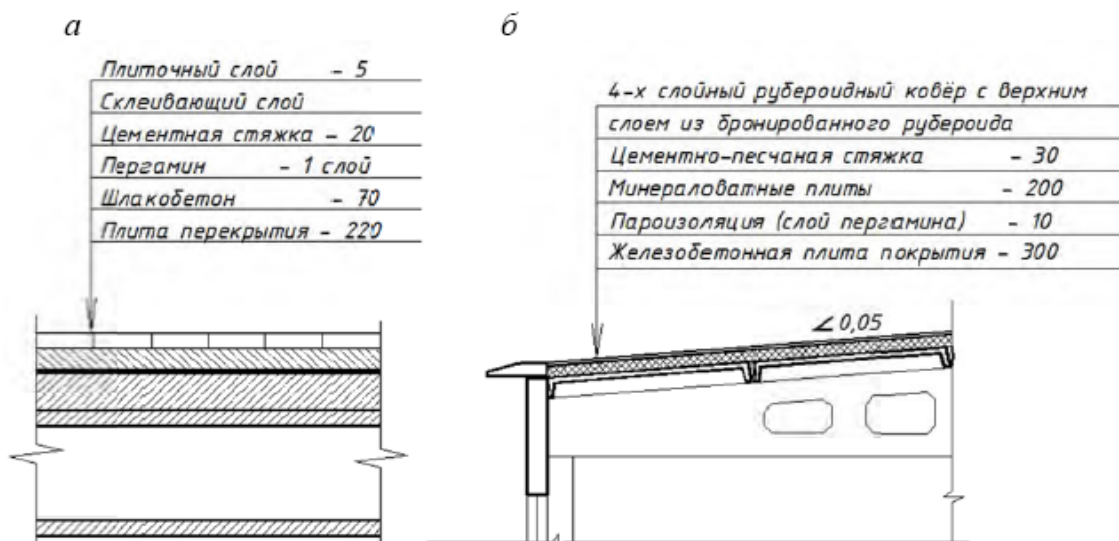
Примеры выполнения выносных надписей к многослойным конструкциям : а) конструкция пола на перекрытии жилого здания; б) конструкция покрытия промышленного здания
